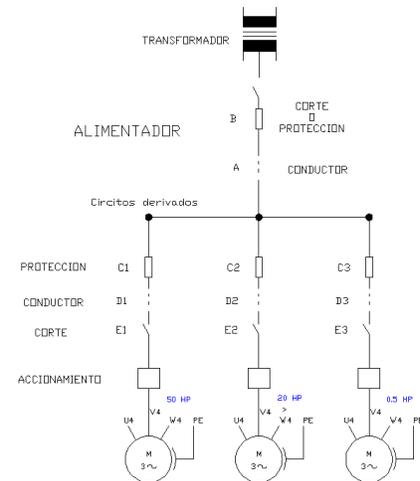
Diagrama unifilar de elementos de corte y protección.
